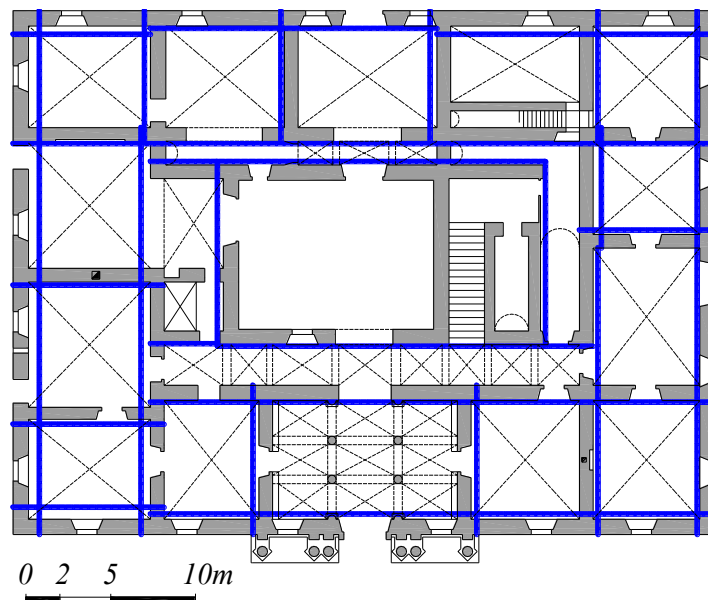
Palazzo Centi, L'Aquila: Pianta piano terra con disposizione catene
